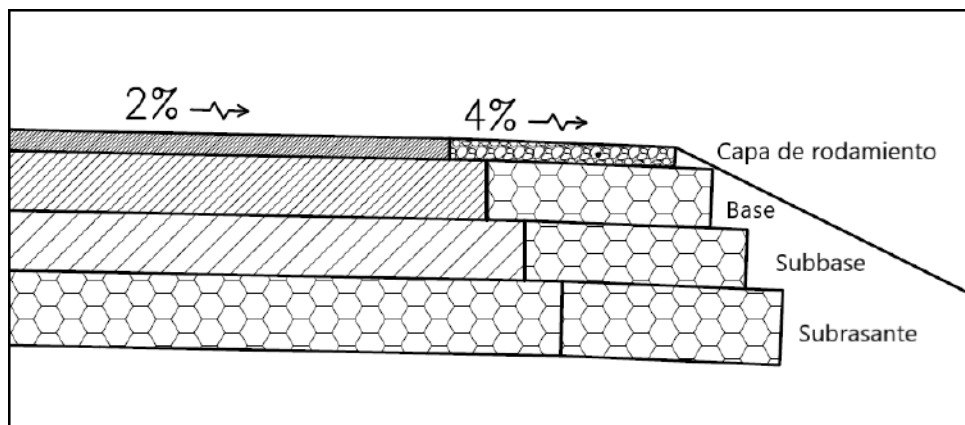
Croquis de paquete estructural Calle Gral. Obligado.
